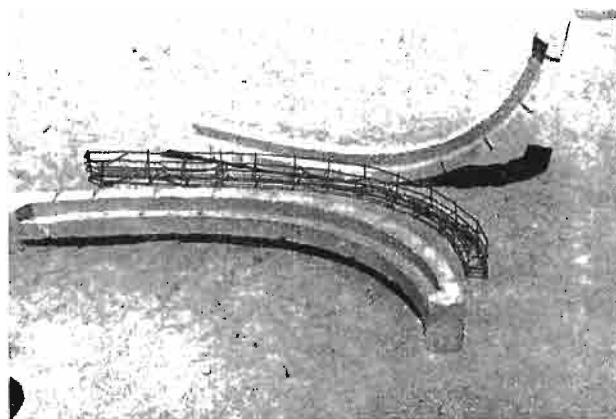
Zmontowany portal żelbetowej obudowy tunelu.
